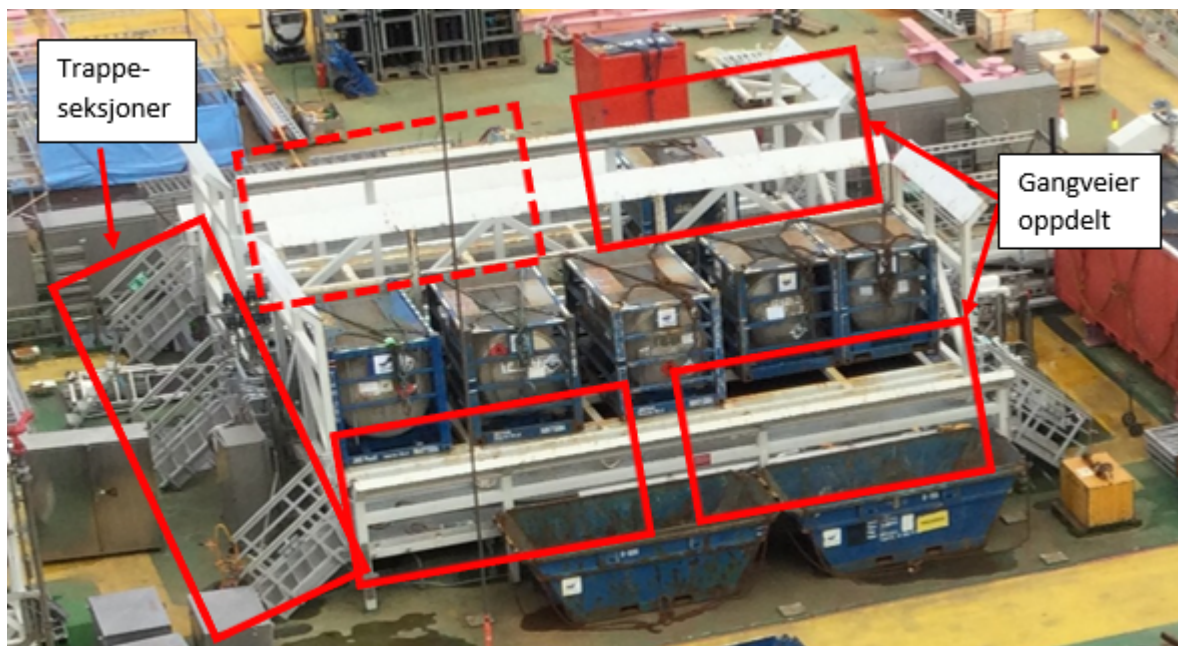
er mottatt av Equinor, og viser stigerørsplattformen
